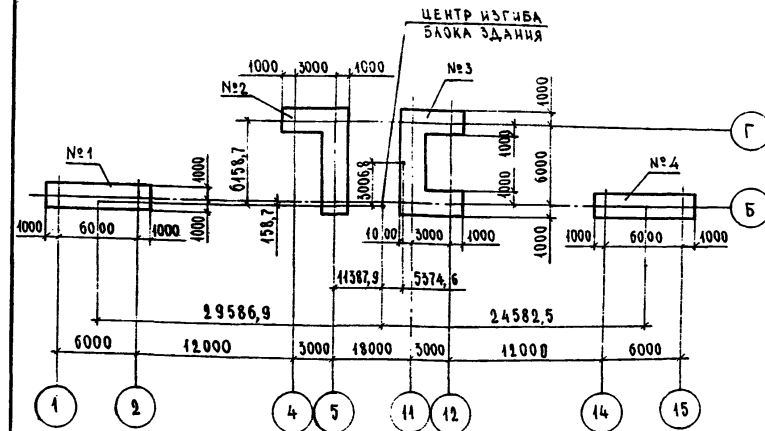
Схематический план фундаментов под диафрагмы блока здания.
